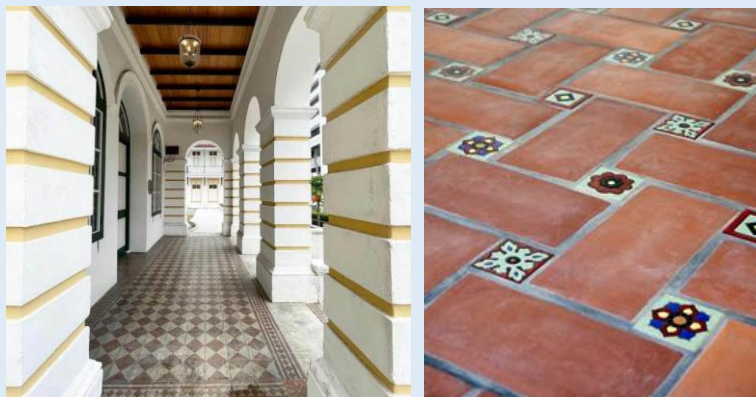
Contoh lantai koridor yang dipelihara dan dikekalkan di bangunan warisan.
